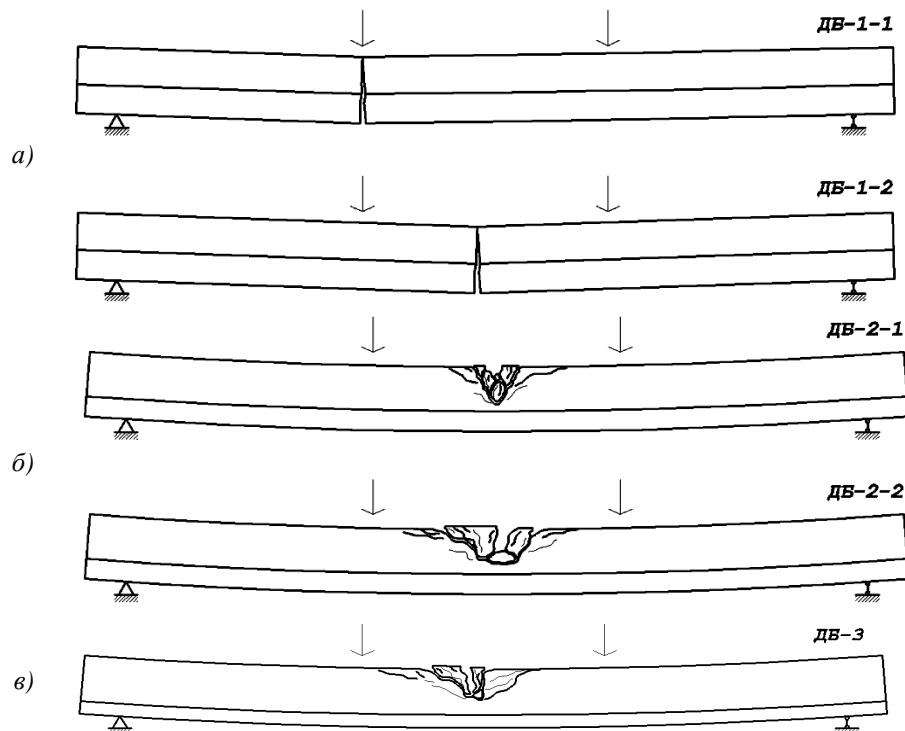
Схеми руйнування дослідних деревобетонних балок:
